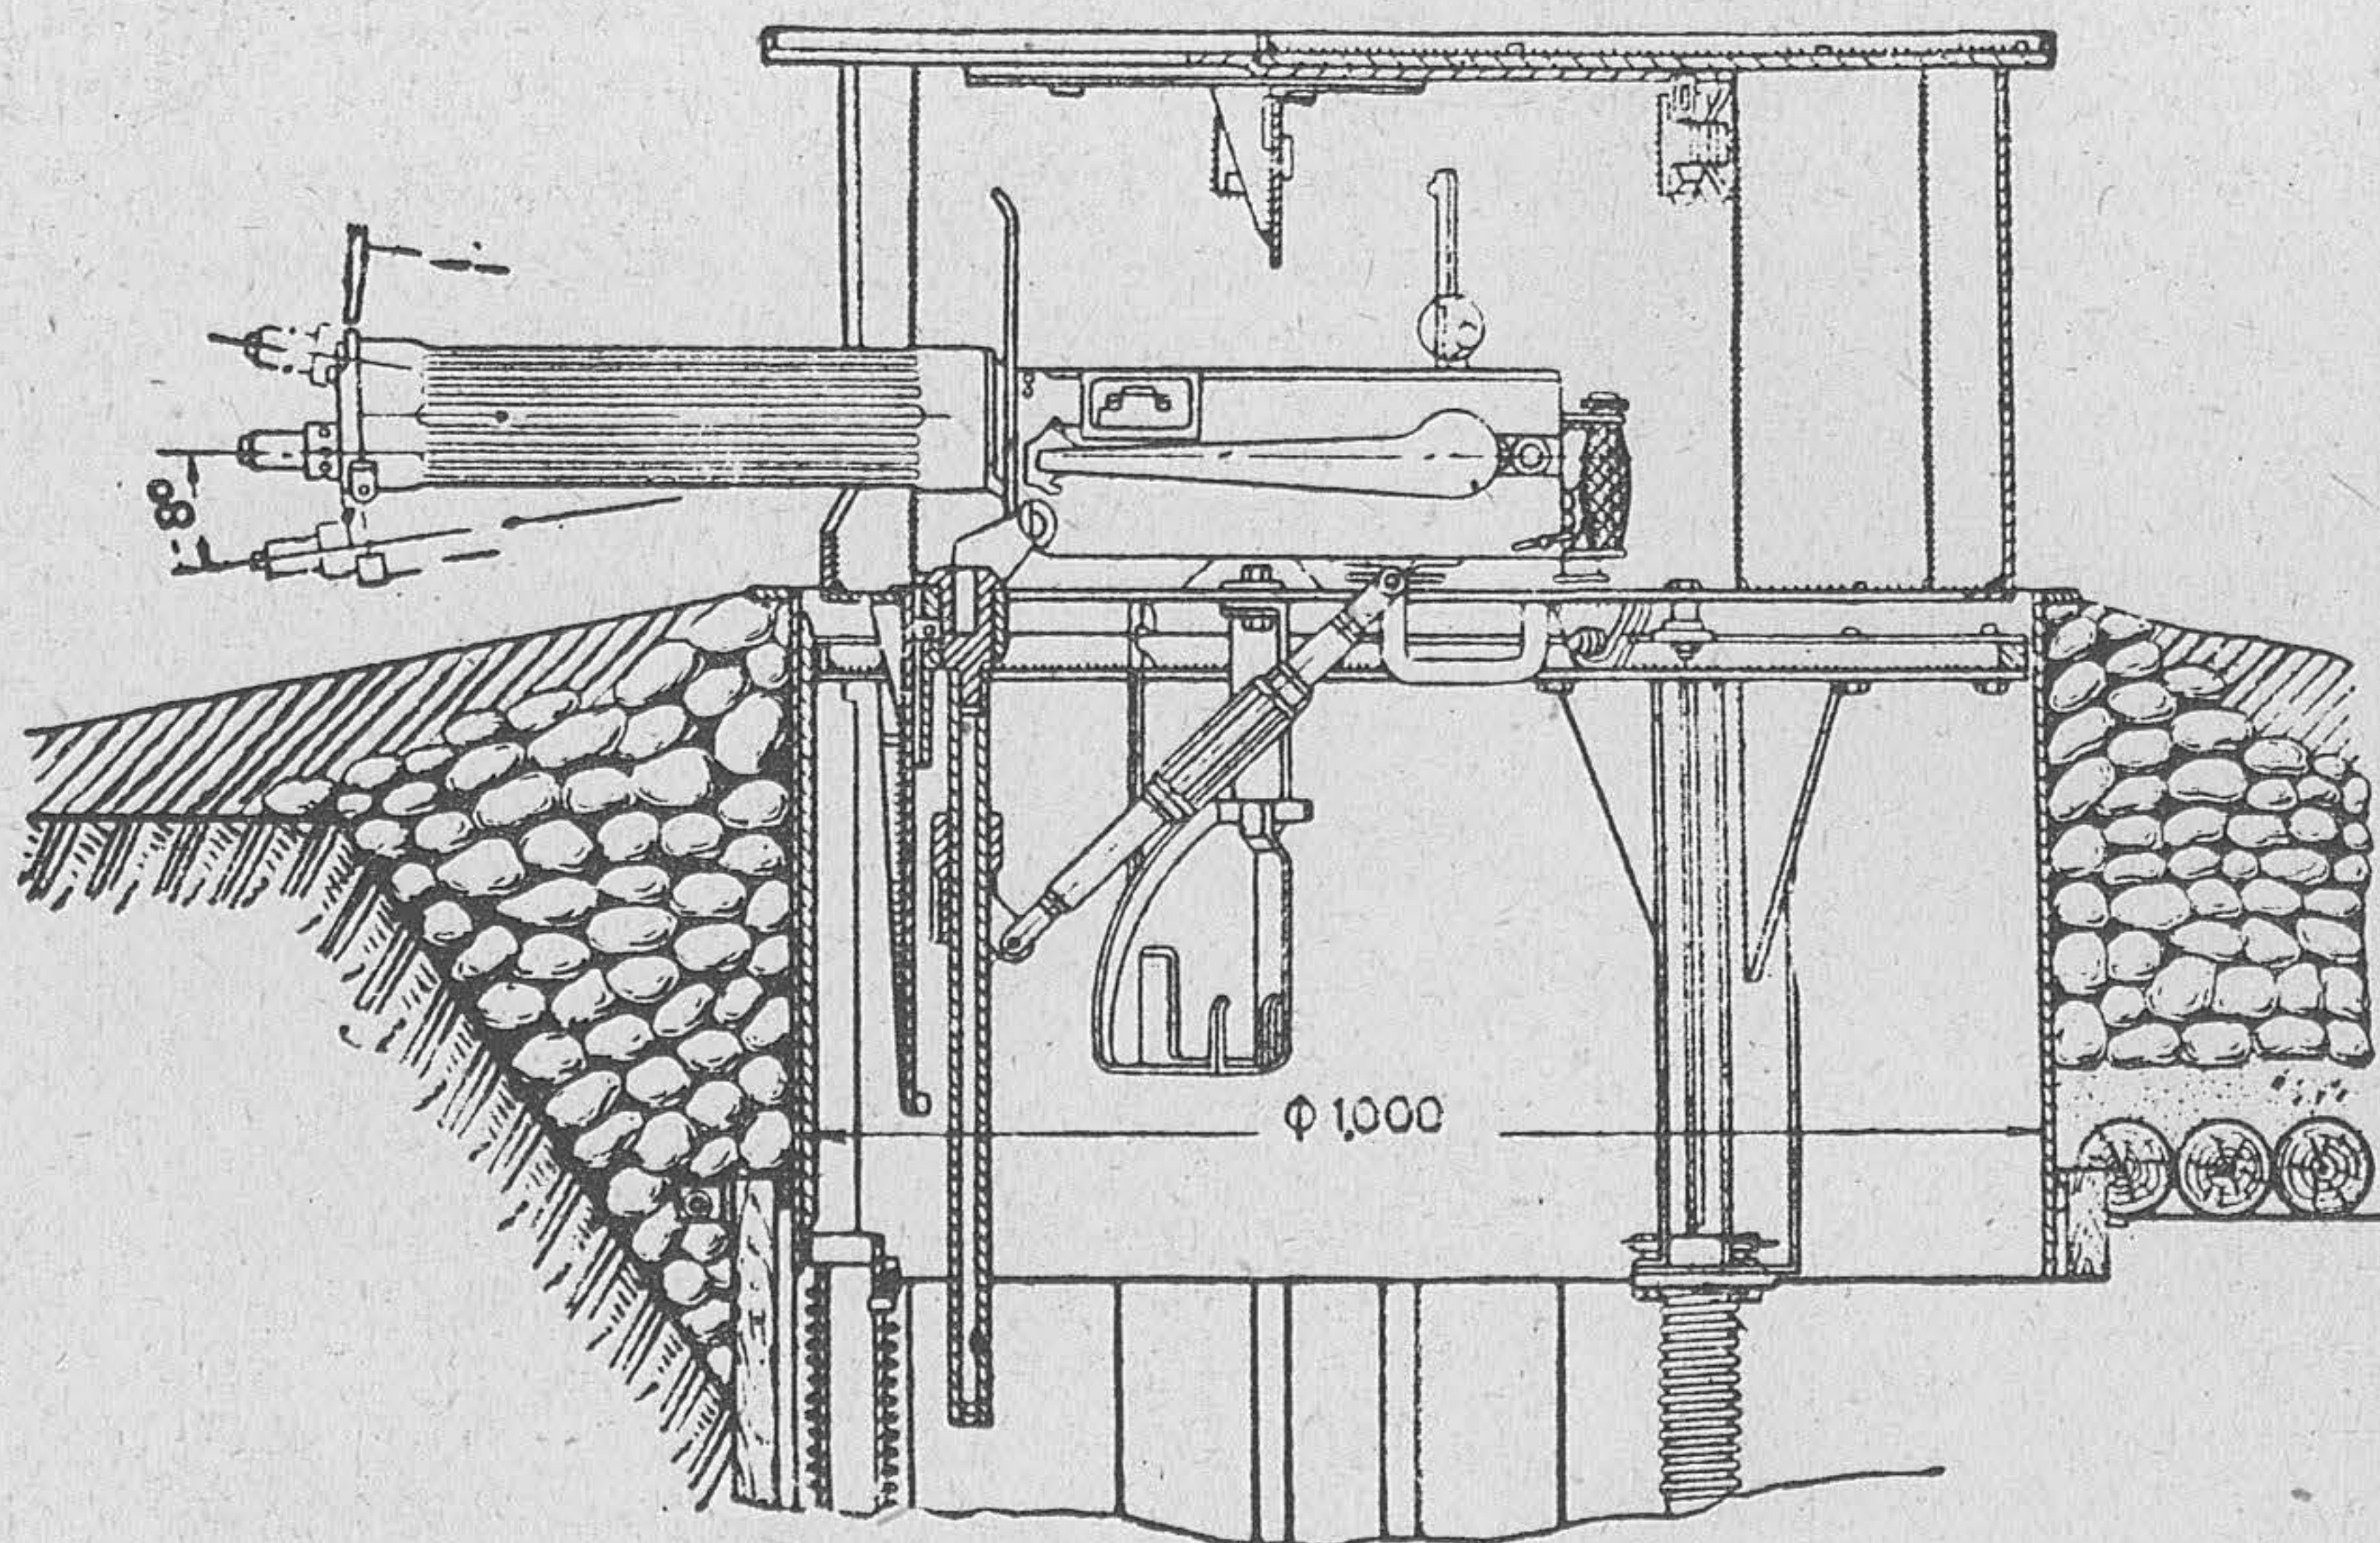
Броневая скрывающаяся пулемётная установка типа BCOT-5
